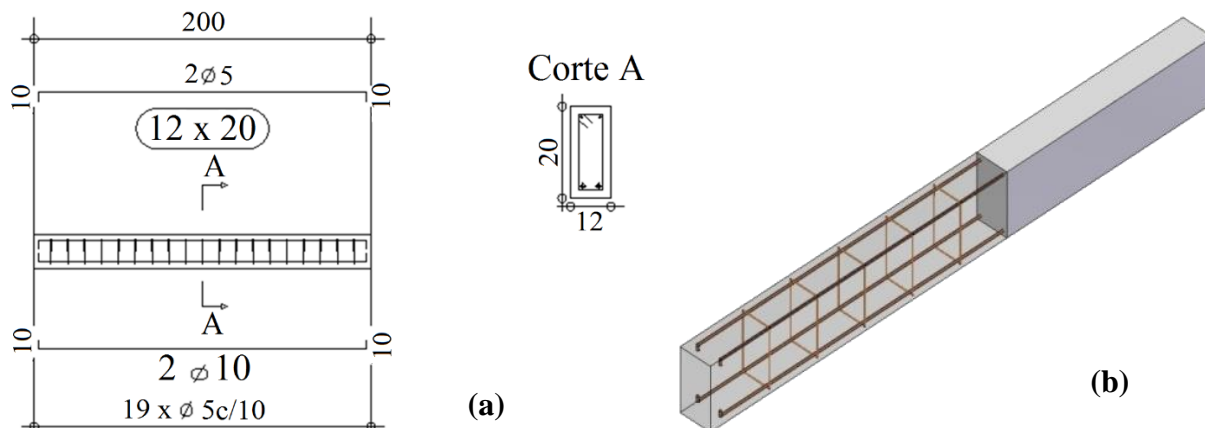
Detalhamento das armaduras nas vigas - (a) Detalhamento longitudinal; (b) Perspectiva da armação.
